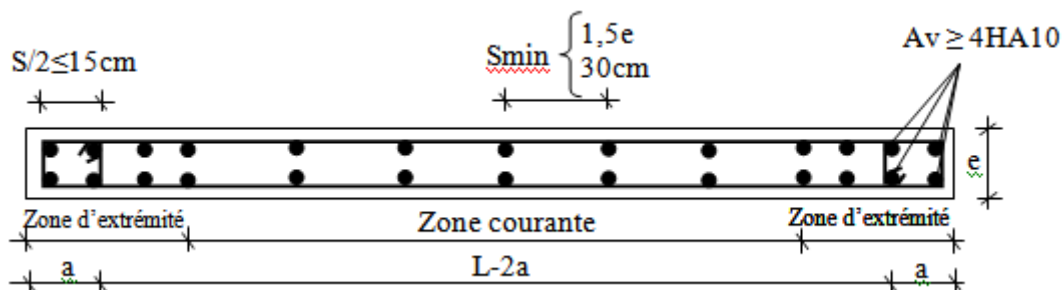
Disposition des armatures verticales dans les voiles.
